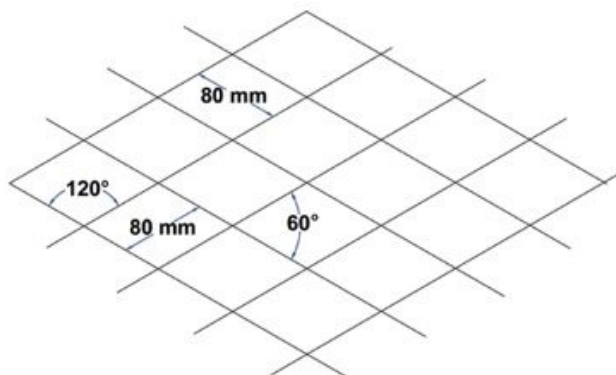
Caratteristiche delle scanalature a rombi in una pavimentazione piana in calcestruzzo.
